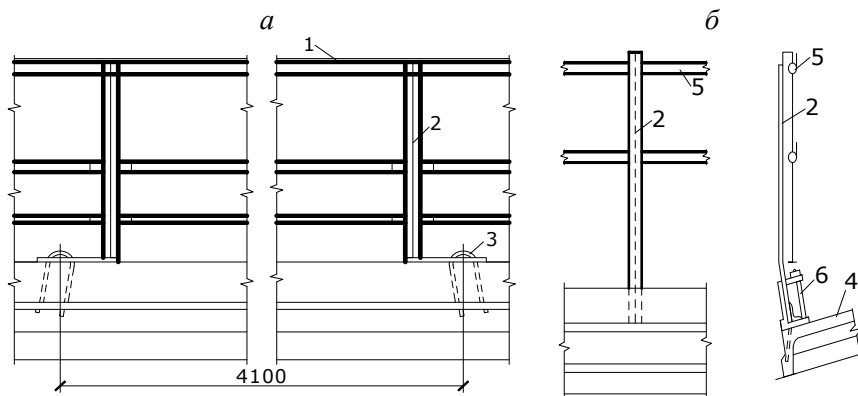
Временное ограждение по плитам покрытия (перекрытия):
